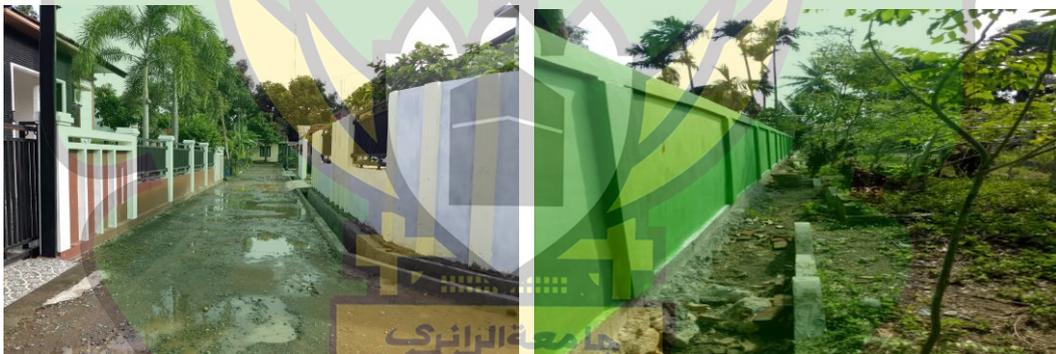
Pembangunan Jalan Dan Irigasi Desa
